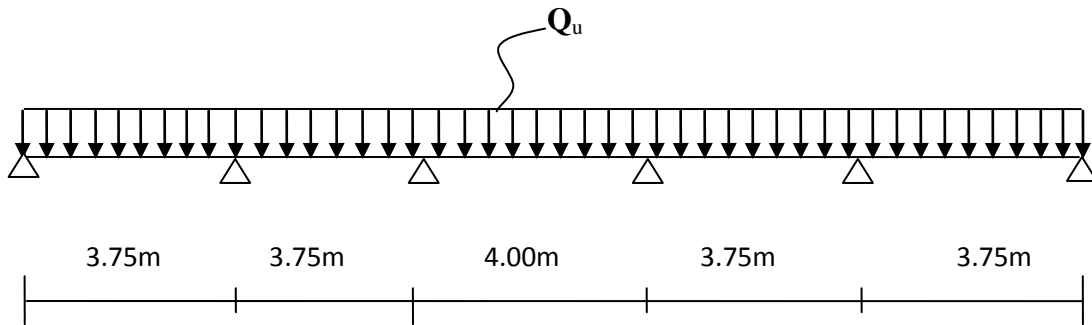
schéma statique d'une poutre sur plusieurs appuis
